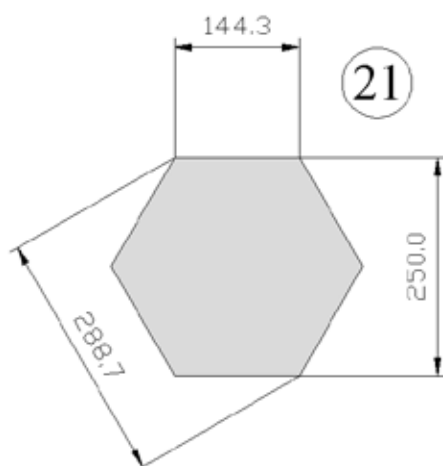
Dimensjoner på sekskantede fliser
